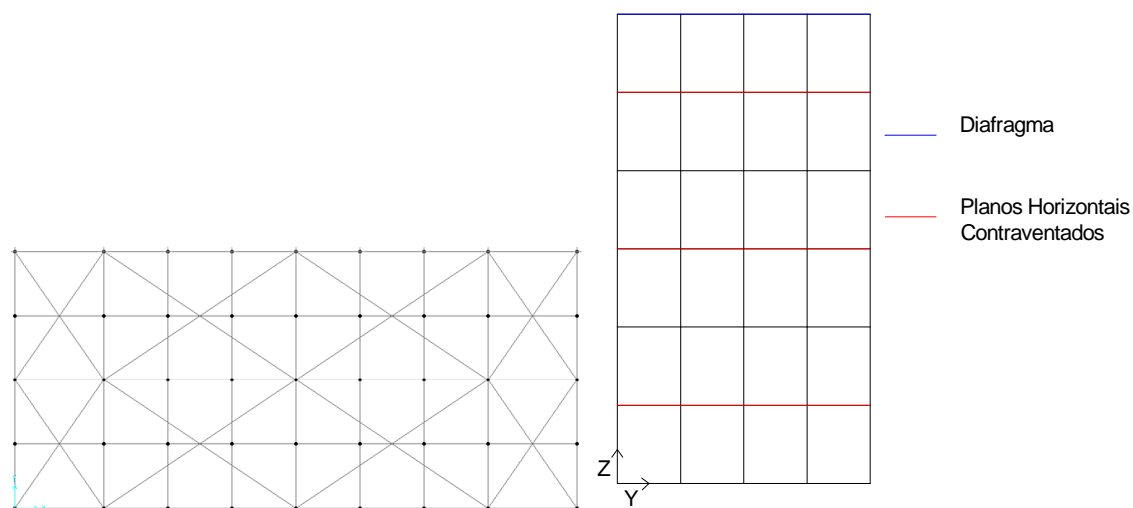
Configuração dos Planos de Contraventamento Horizontal Com Elementos de Contraventamento Grandes
